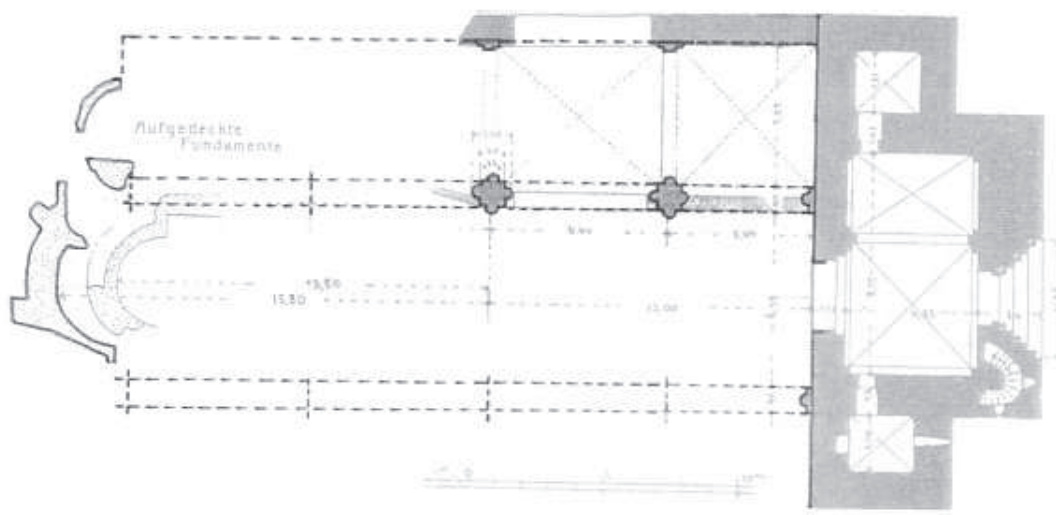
Marienkirche, Grundrissrekonstruktion der zweiten Kirche aus dem 12. Jahrhundert.
